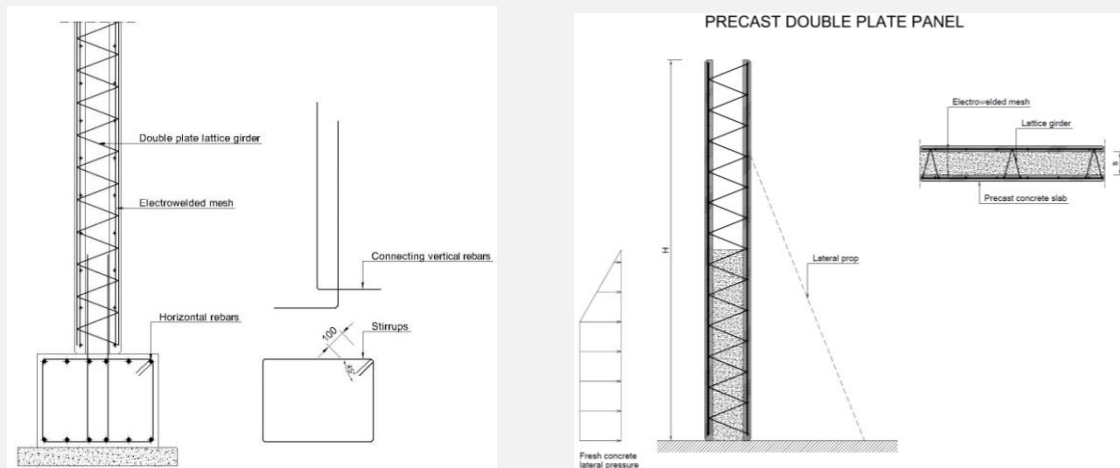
Detaliu structural tipic pentru îmbinarea dintre peretele din b.a. și fundație (secțiune verticală).
